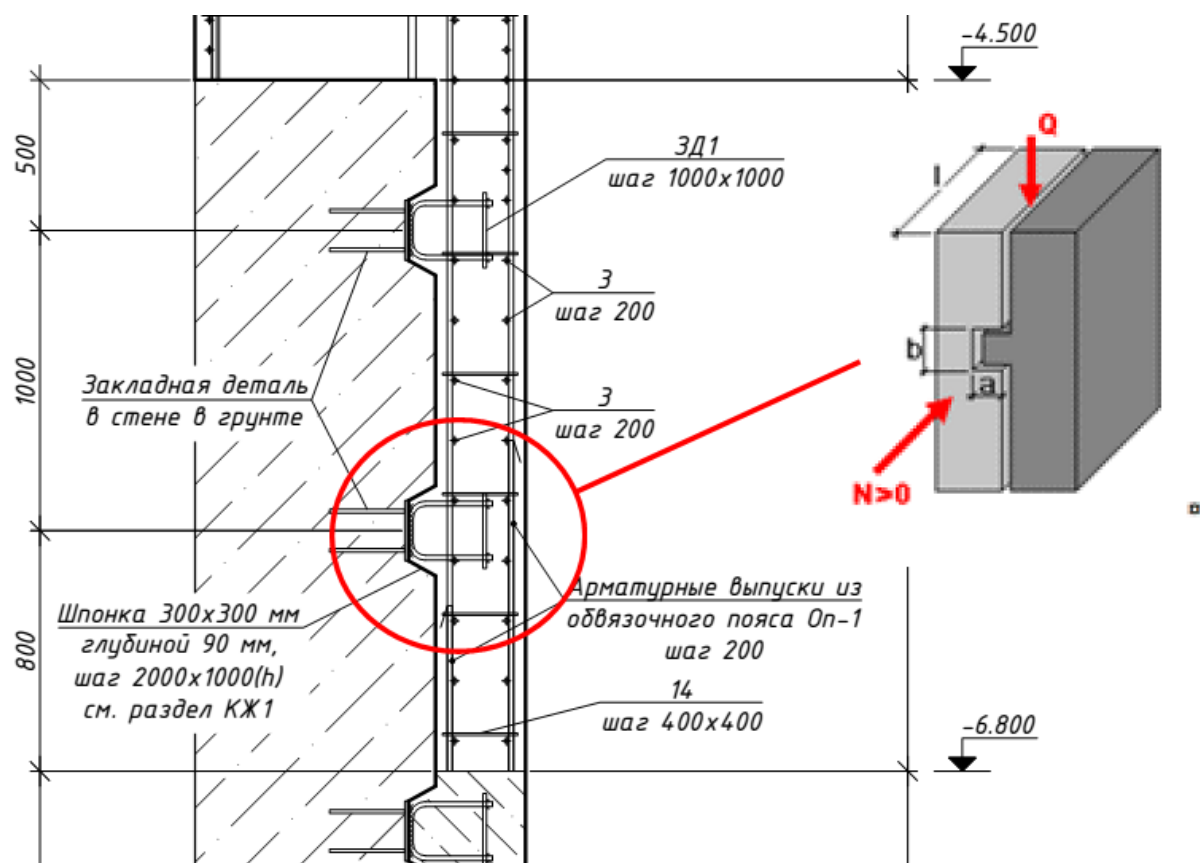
Узлы сопряжения наружной стенки резервуара со стеной в грунте
